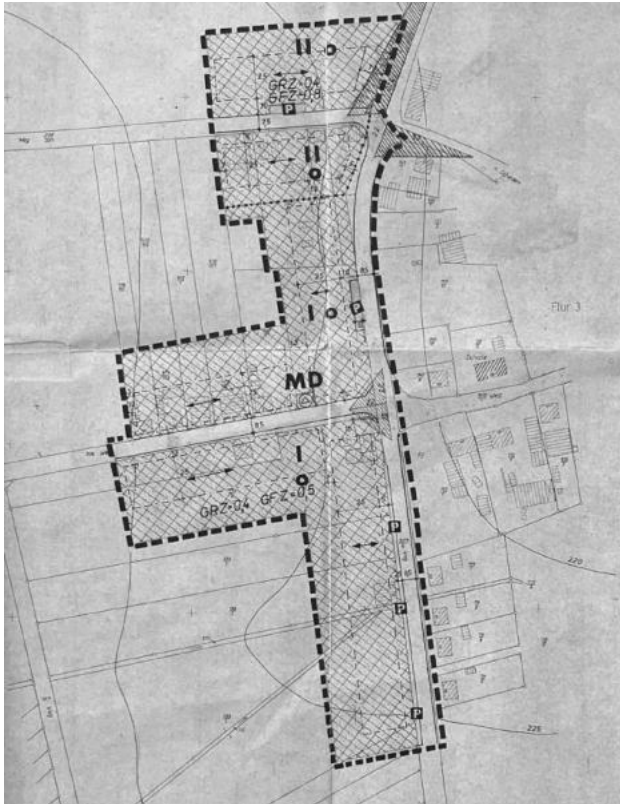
Ur-Bebauungsplan aus dem Jahre 1972 (ohne Maßstab)
